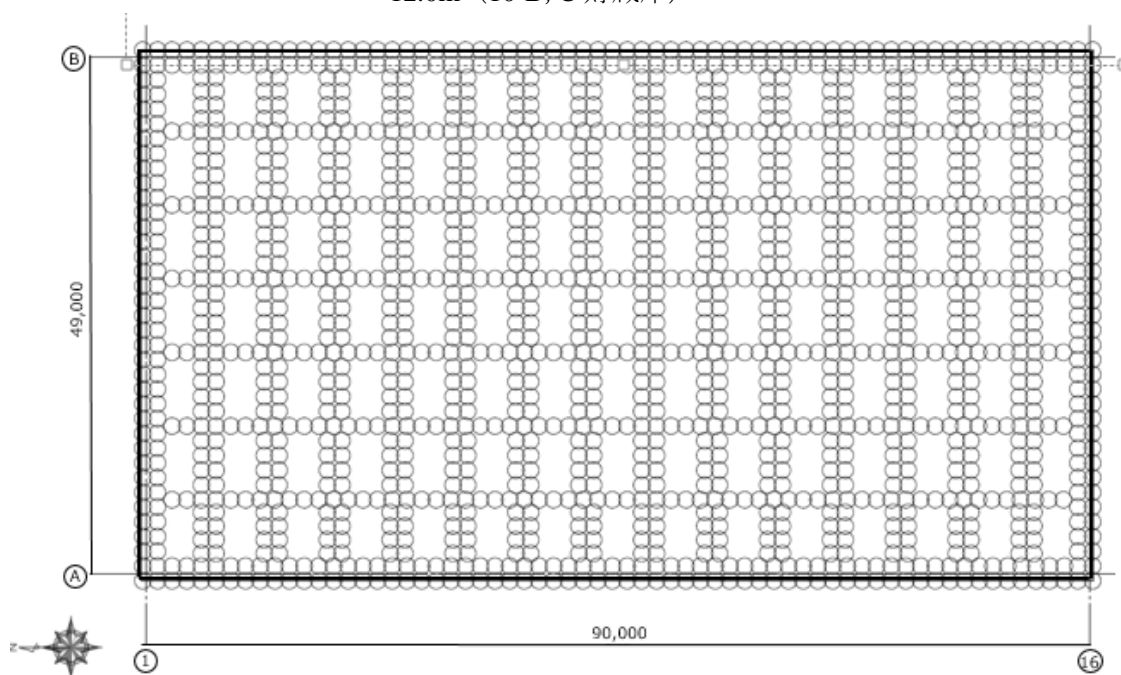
基礎スラブ平面図, 断面図 (例 10-A 貯蔵庫)
